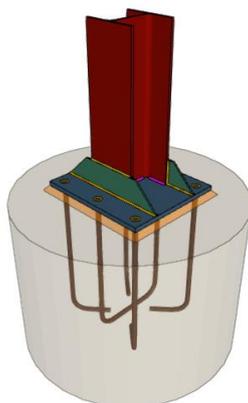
Vista unión pilar-cimentación pilares de esquina
